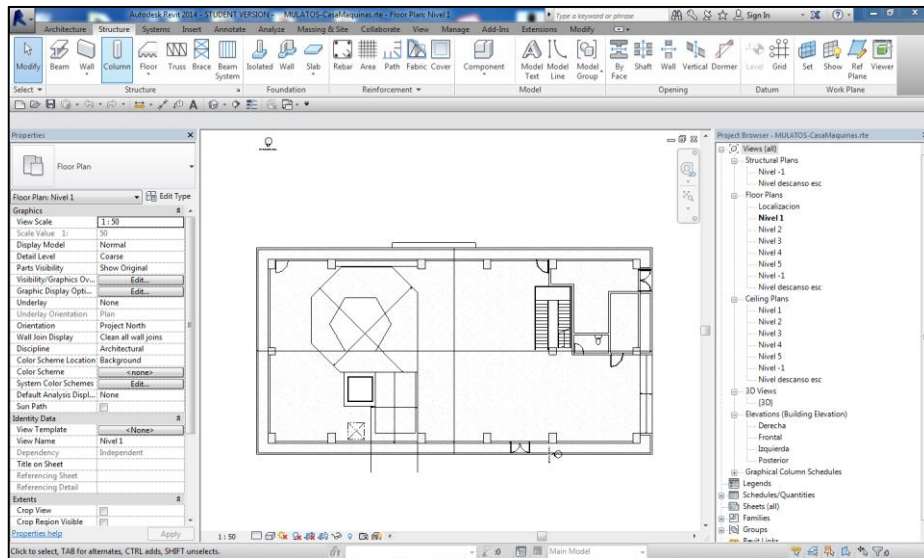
Planta primer nivel casa de máquinas importada a Revit
